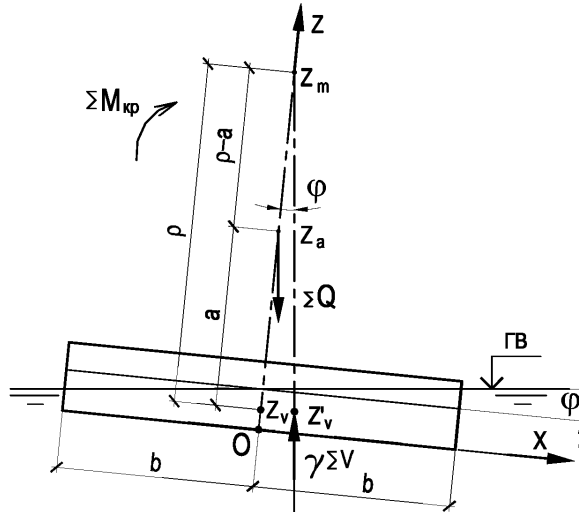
Схема определения устойчивости плавучей опоры
